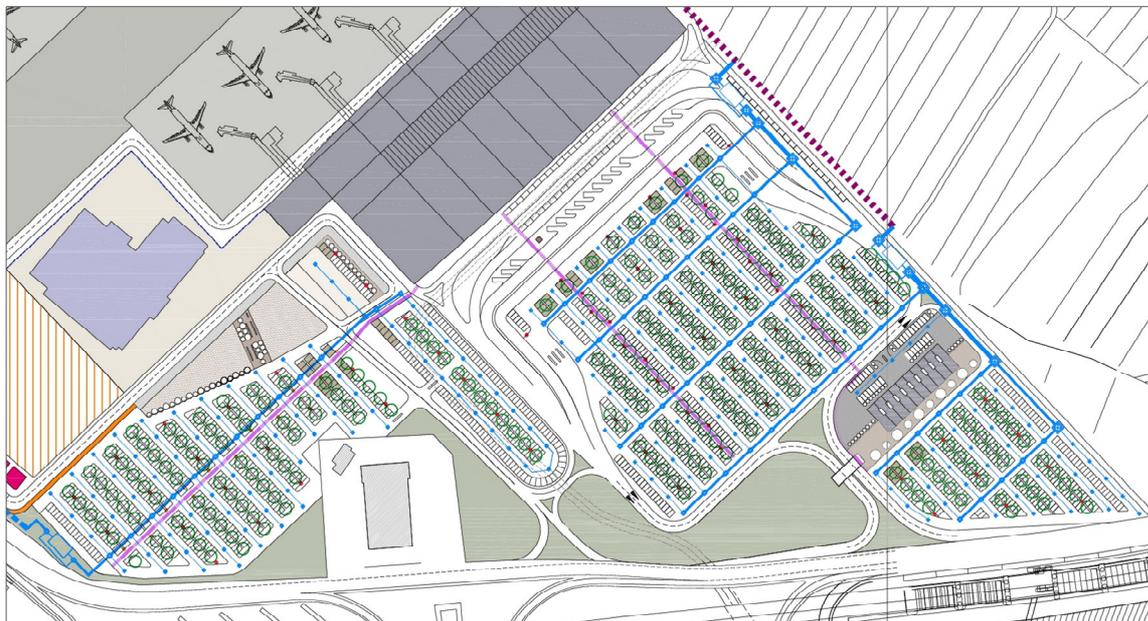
AEROPORTO DI FIRENZE – Planimetria schema smaltimenti
